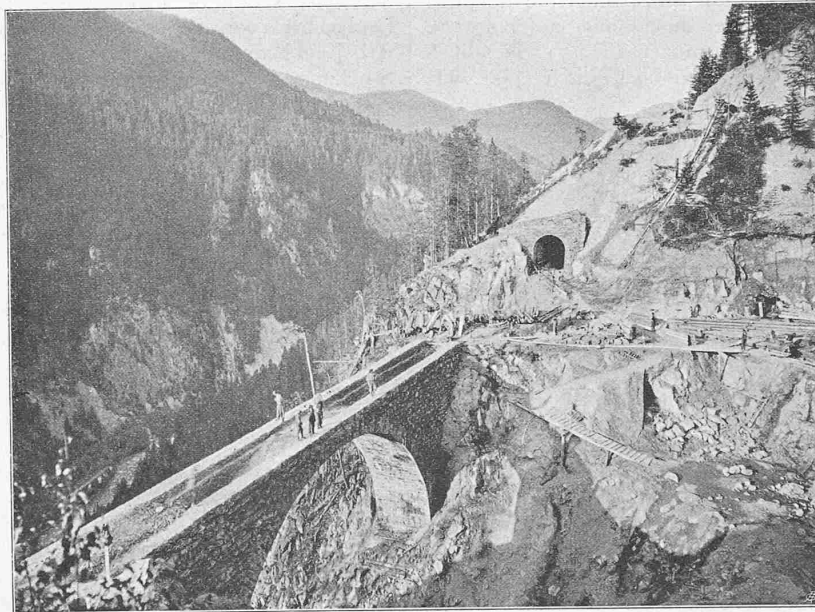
Pflanzgartenbrücke II, nach Vollendung des Mauerwerks.
